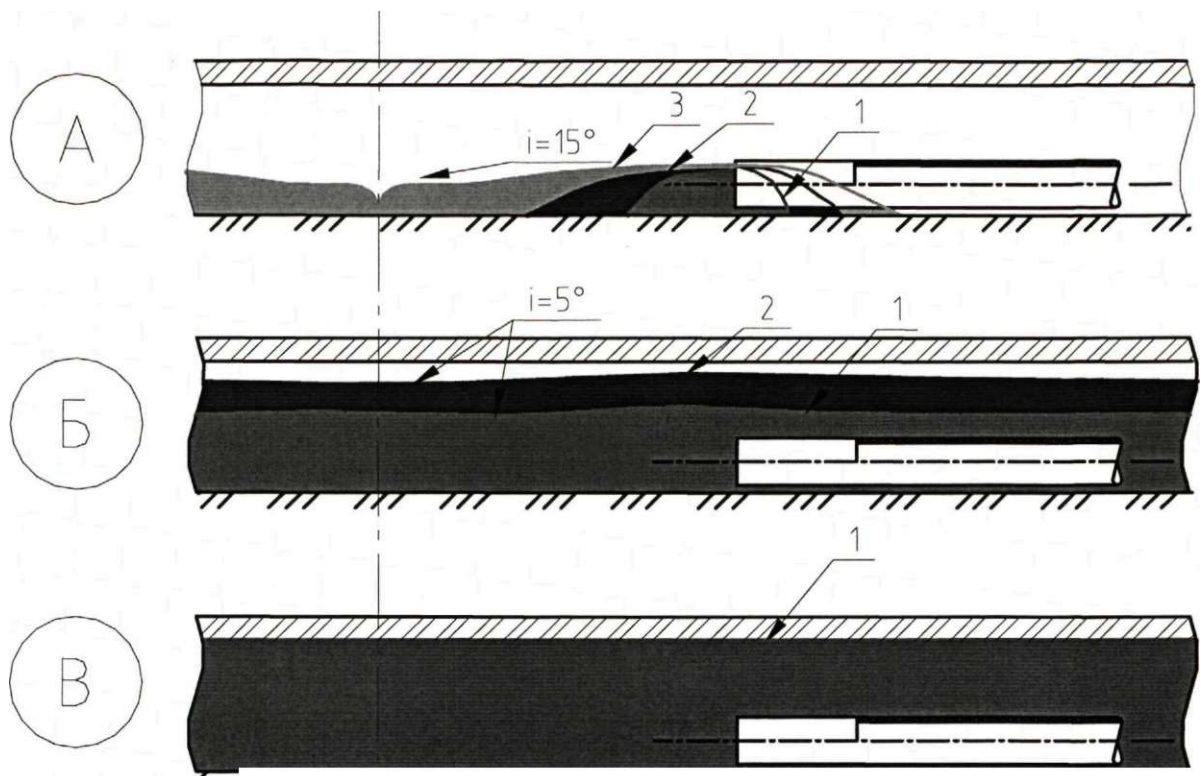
Схема руху бетонної суміші в порожнині при подачі її допомогою бетоноводов з декількох сторін: А, Б, В індекси схем; 1, 2, 3 етапи просування суміші
